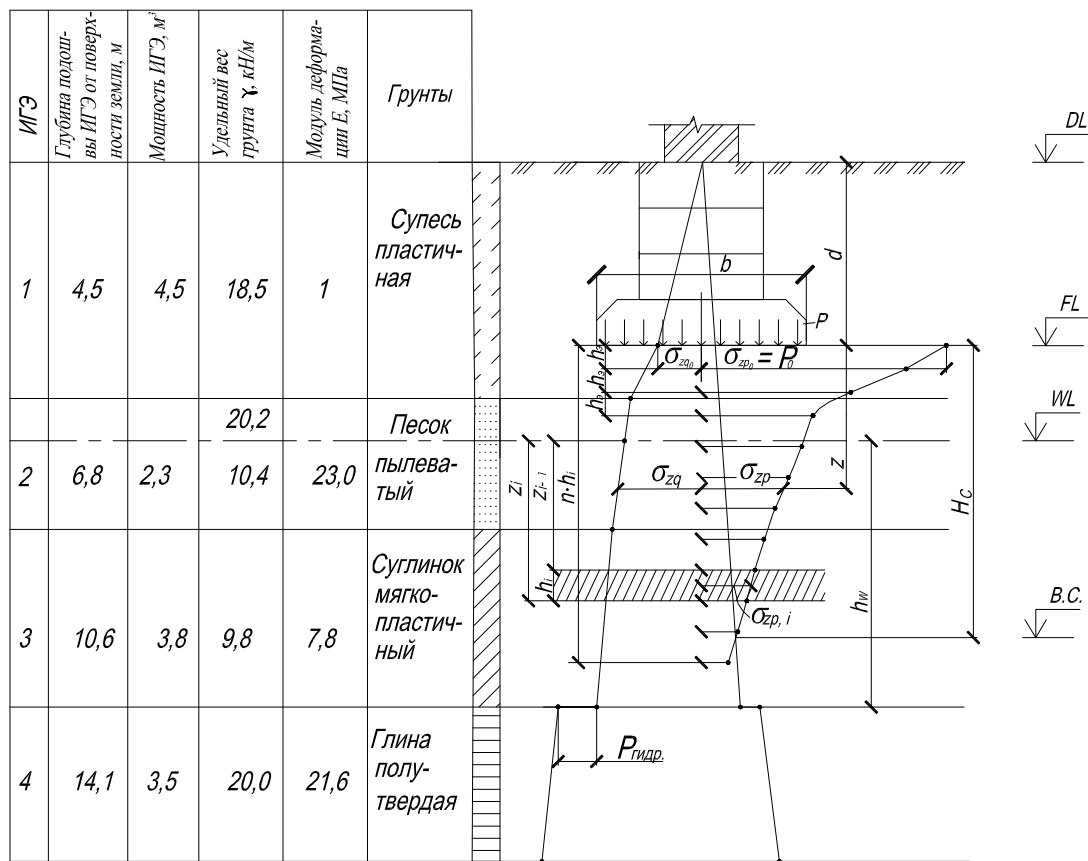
Схема к расчету осадки фундамента методом послойного суммирования:
